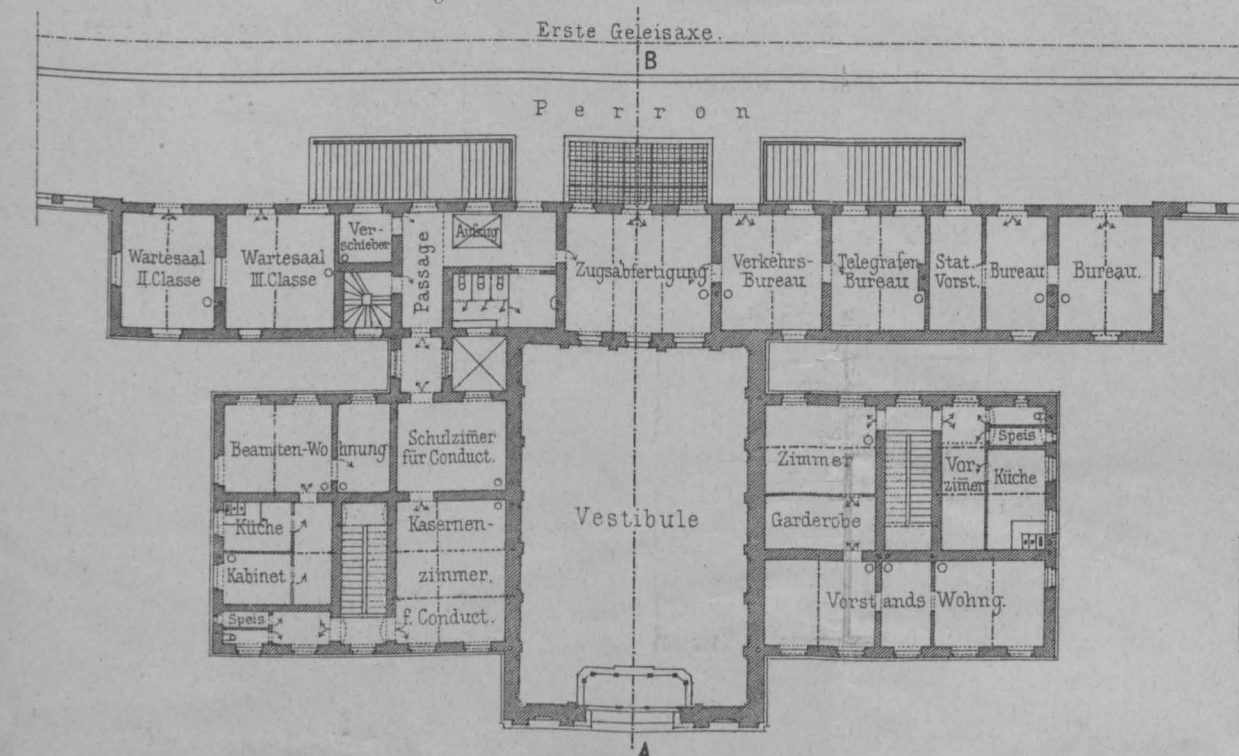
Grundriss Haltestelle Kettenbrücke 1:300
